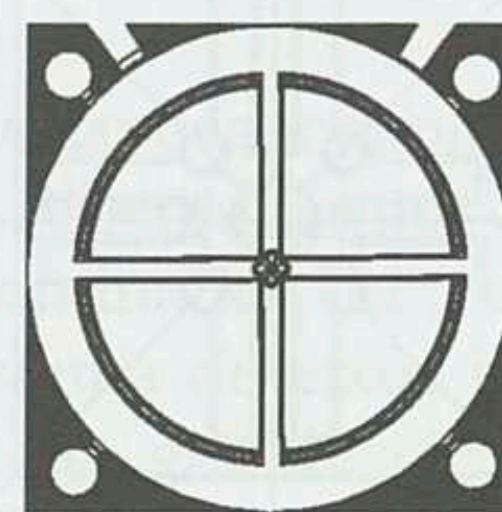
Fonte do Claustro da Manga, Mosteiro de Santa Cruz, planta e traçado geométrico.
